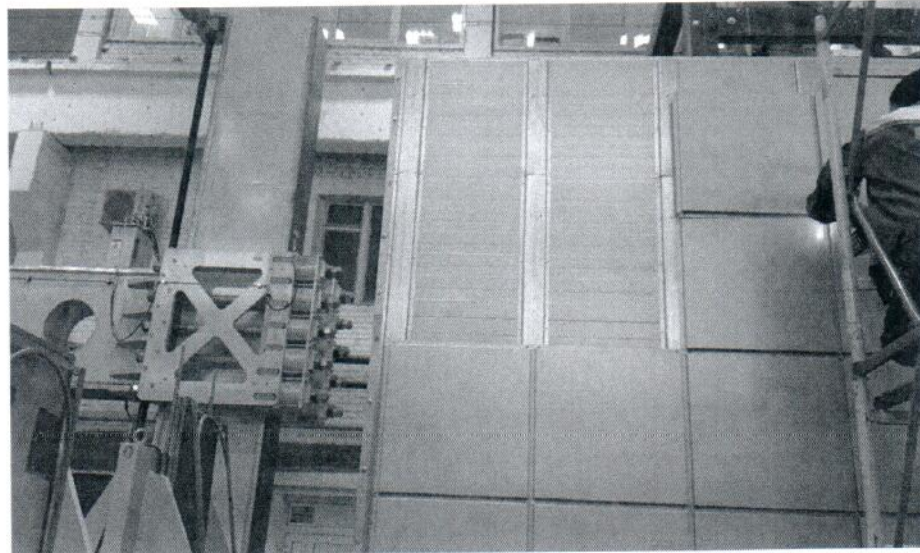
Момент монтажа облицовки в виде фасадных кассет PUZZLETON Z к панелям
